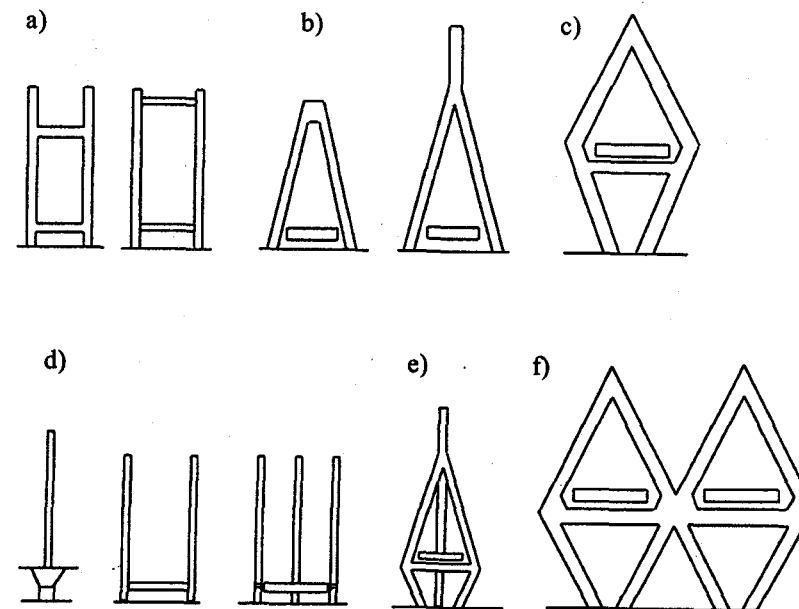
Filary żelbetowe dla przęseł belkowych [8]
